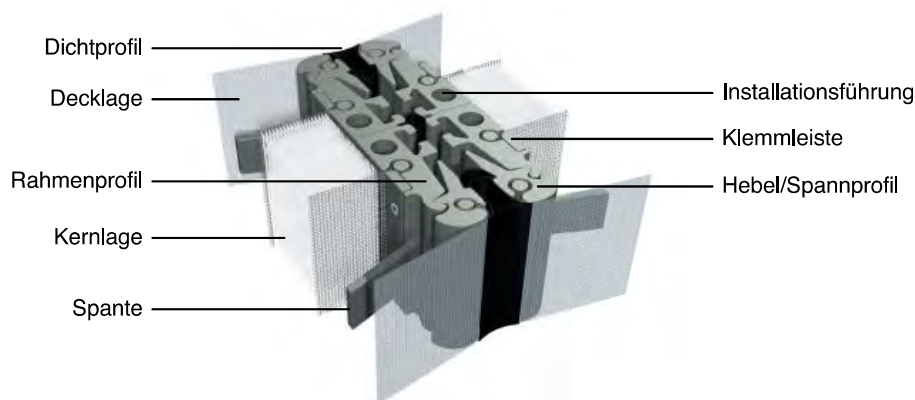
Profil der textilen Elementfassade mit Bauteilfügung [2]
